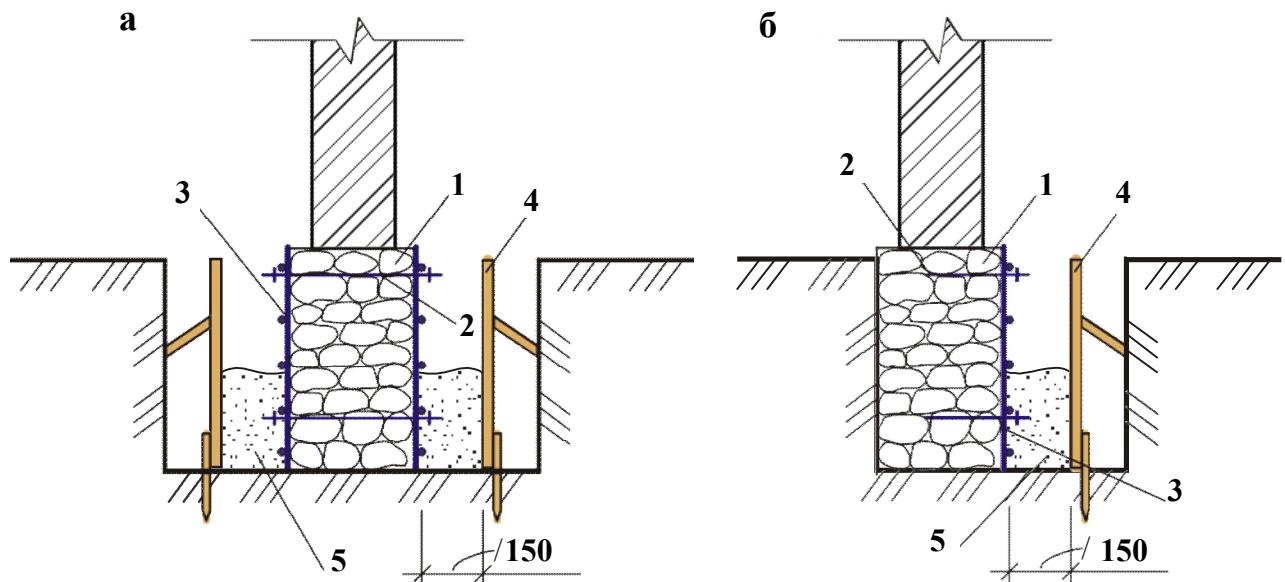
Посилення бутових фундаментів шляхом влаштування залізобетонної обойми: а – двобічної; б – однобічної; 1 – бутовий фундамент; 2 – анкер; 3 – арматурна сітка; 4 – опалубка; 5 – бетонна суміш
